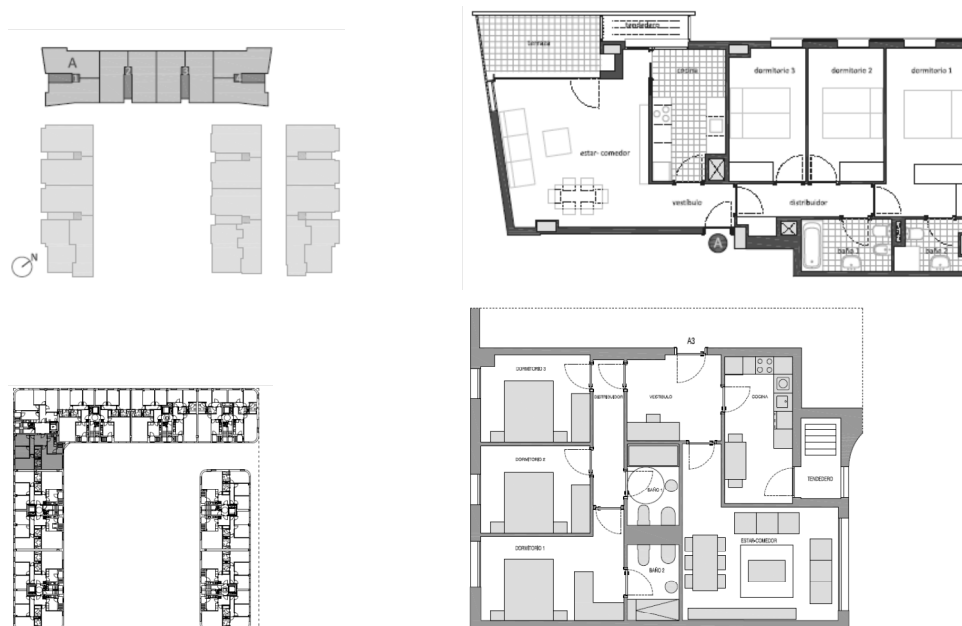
Arriba: 145 Viviendas Protegidas Tasadas. Plano de promoción y planta de distribución de vivienda de 85 m² útiles. Grupo Proginisa [www.proginisa.com]; Abajo: 114 viviendas en Lezkairu. Plano de promoción y planta de distribución de vivienda de 90 m². Promociones Plazaola. Vaillo+Irigaray arquitectos [www.vailloirigaray.com].
